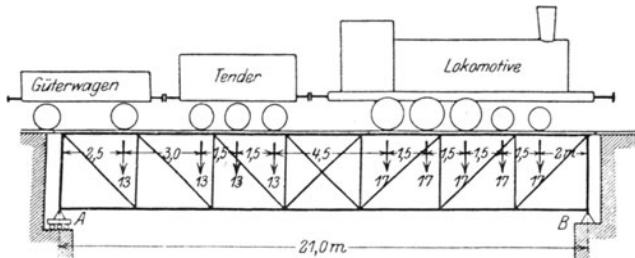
Eisenbahnbrücke mit Belastung (Lasten in Tonnen zu je 1000 kg).
